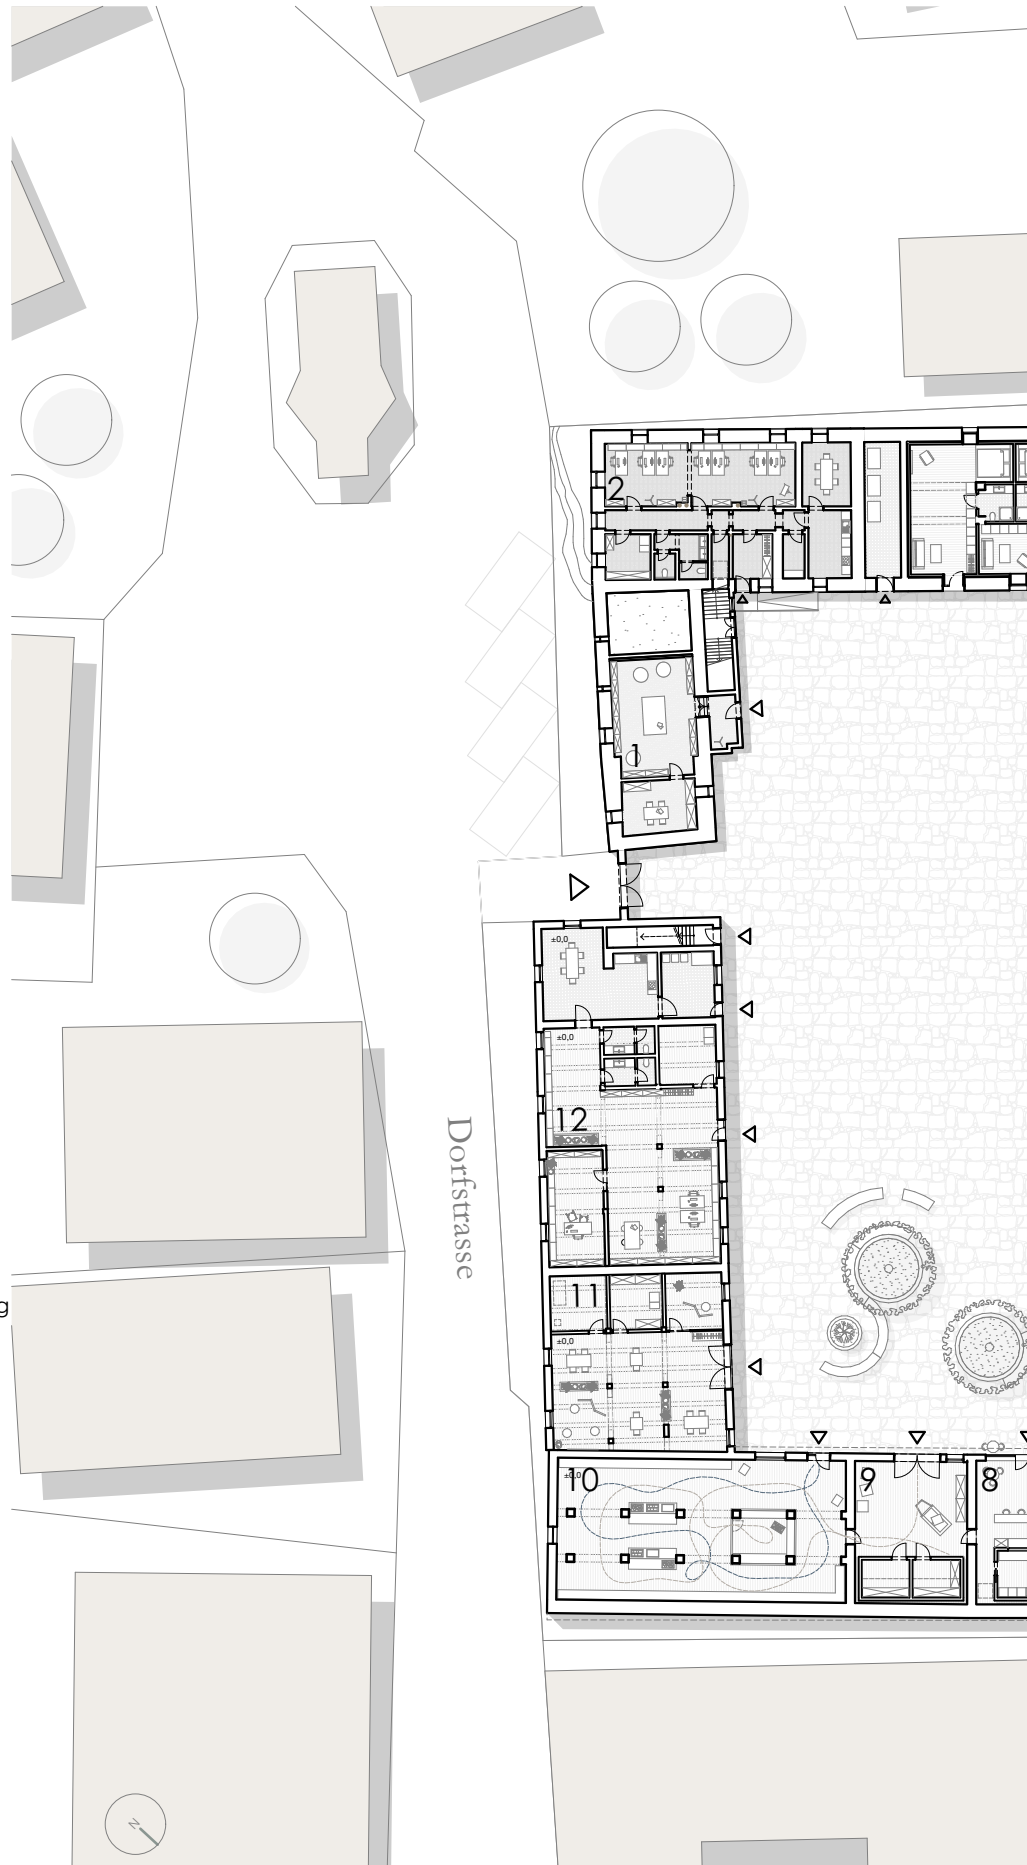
Lageplan, Meierhof M. 1:1000
